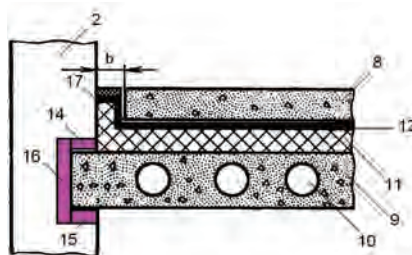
Фрагмент междуэтажного перекрытия здания в разрезе
